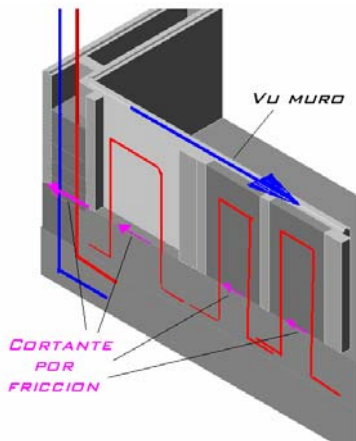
REFUERZO DE TRANSFERENCIA DE CORTANTE ENTRE LA CIMENTACIÓN Y LA PRIMERA HILADA
